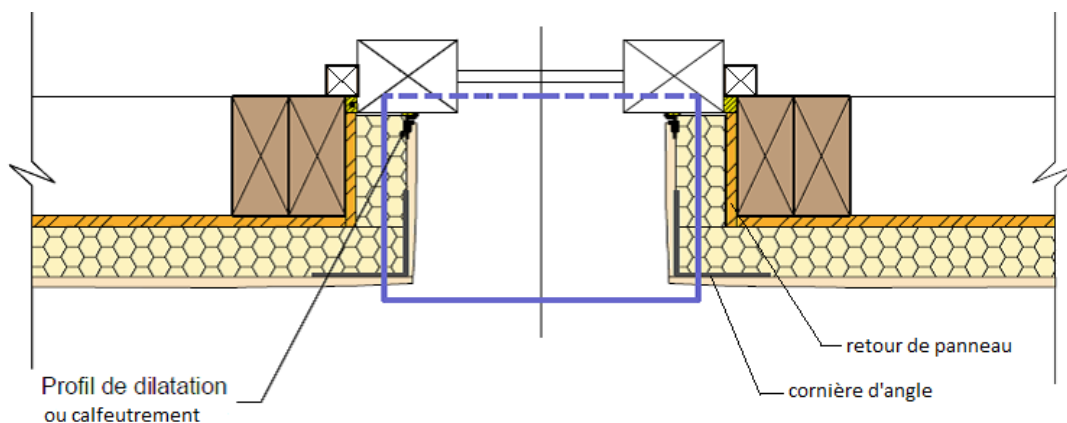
Retour d'enduit en tableau (Ee1) – coupe horizontale
